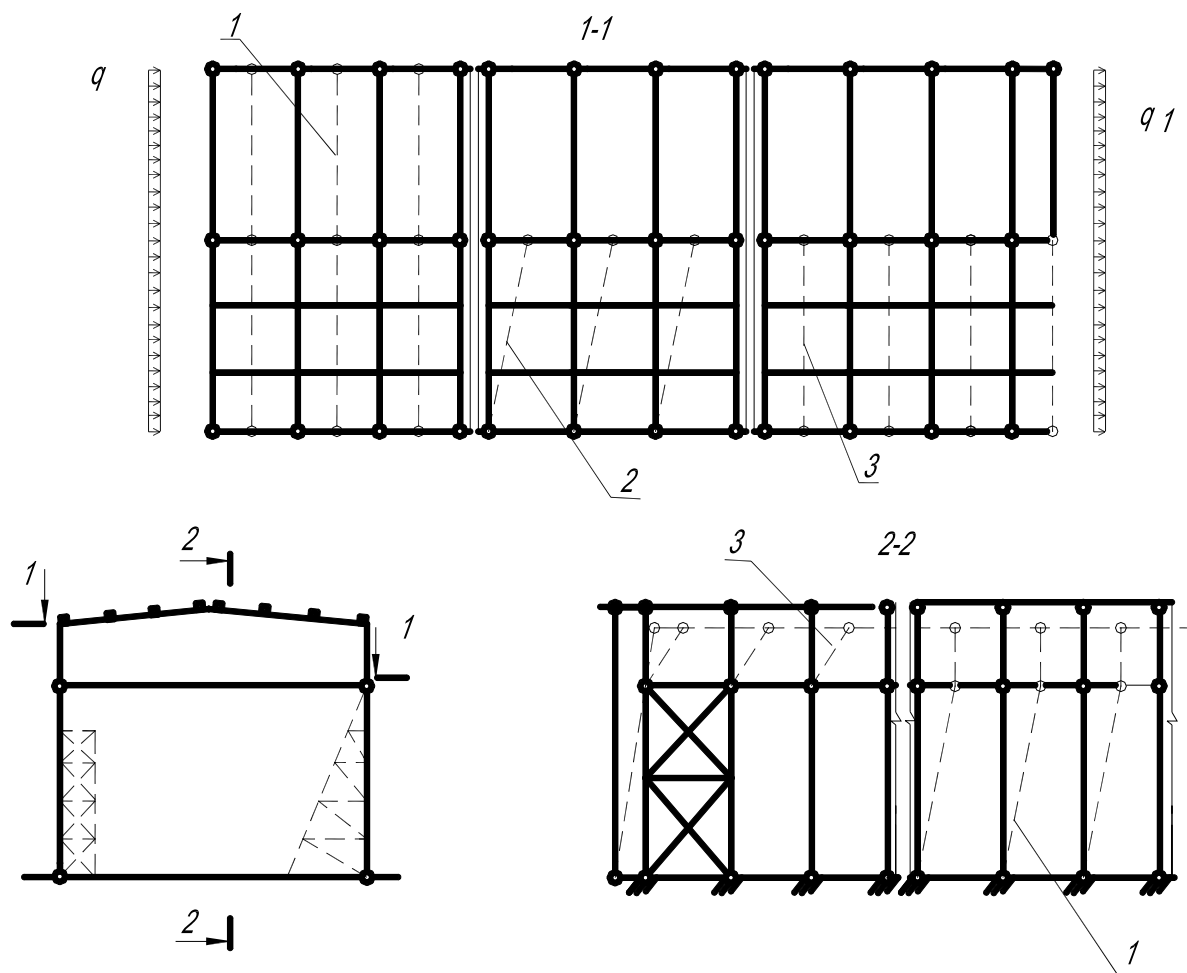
Кинематическая схема каркаса здания без связей с заземленными колоннами
